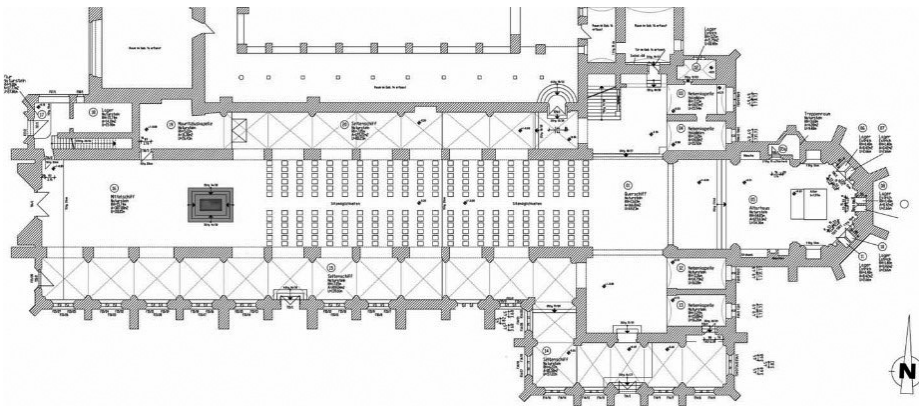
Grundrissplan des Erdgeschosses der Klosterkirche St. Marien in Schulpforte im Maßstab 1:100. Die Tumba befindet sich im ersten Joch des Mittelschiffes im Westteil der Kirche.
